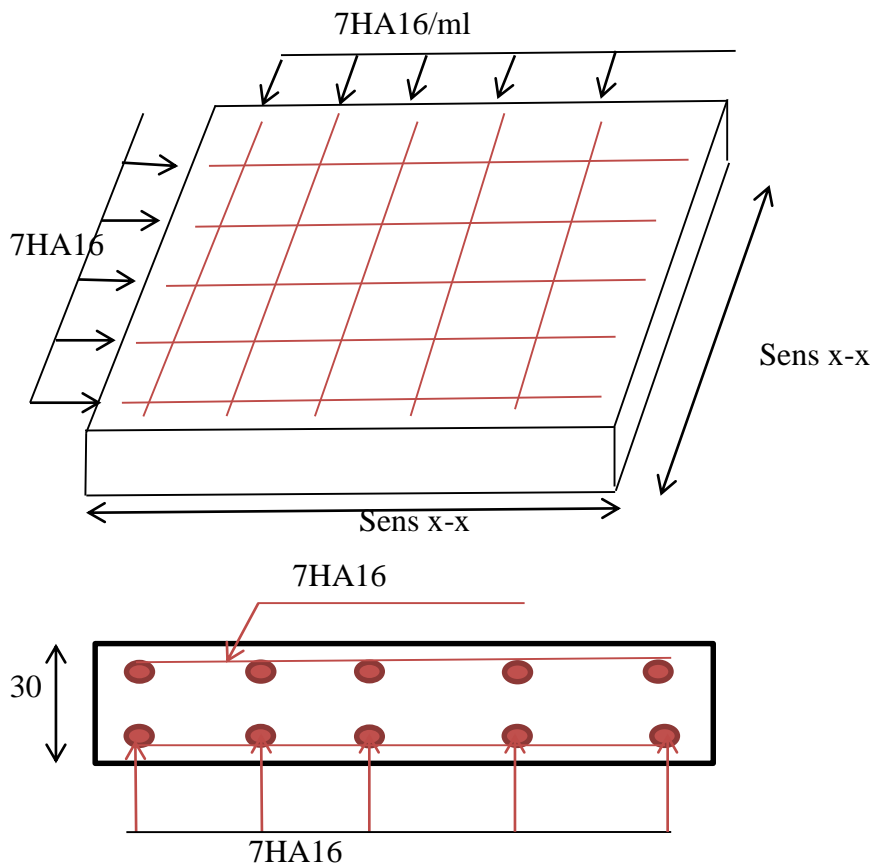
Schéma de ferrailage de la dalle du radier
